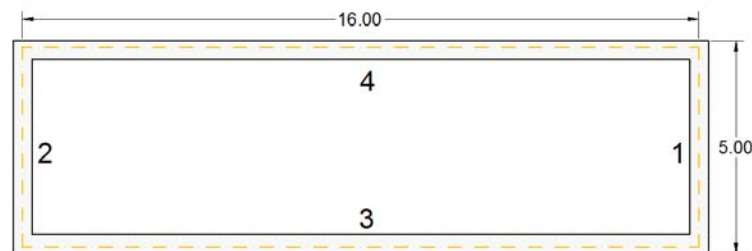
b Esquema planta cimentaciones arquetipo I
